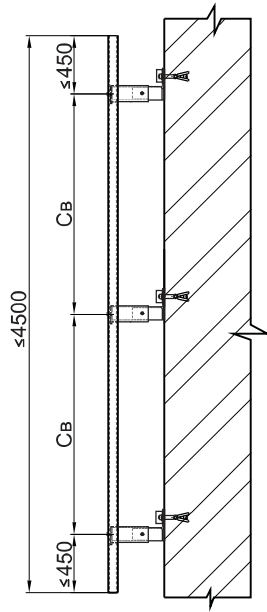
Узел крепления кронштейна КУ к стене двумя анкерами.
